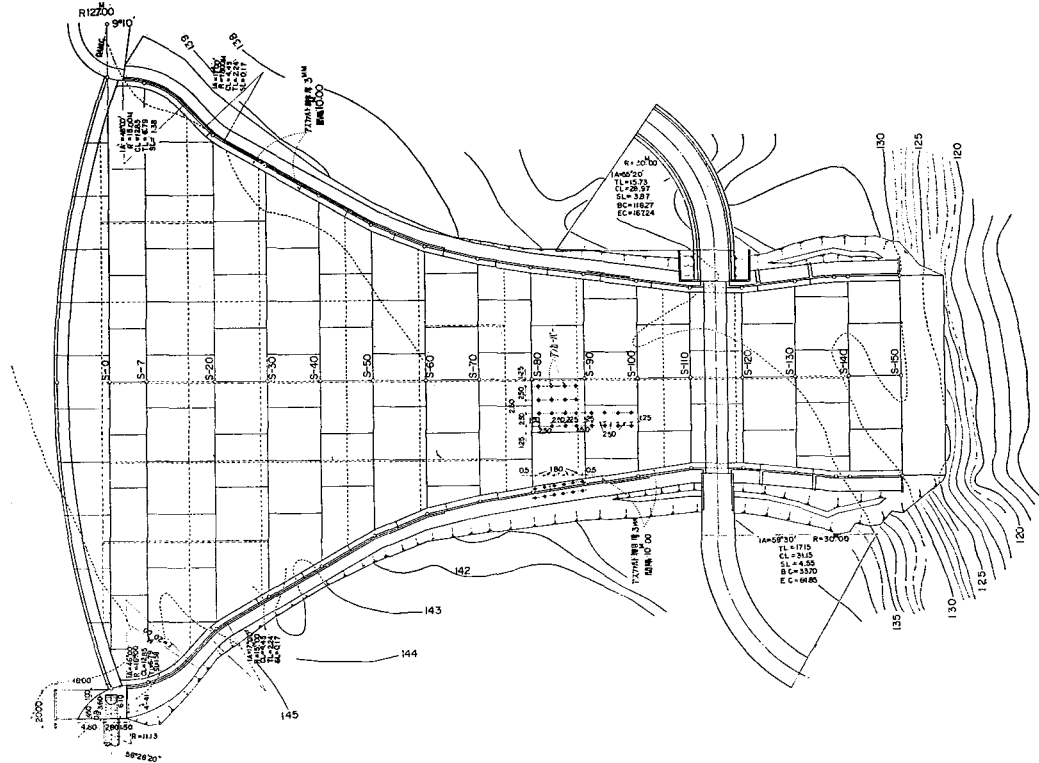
北海道青山ダム余水吐放水路一般平面図
